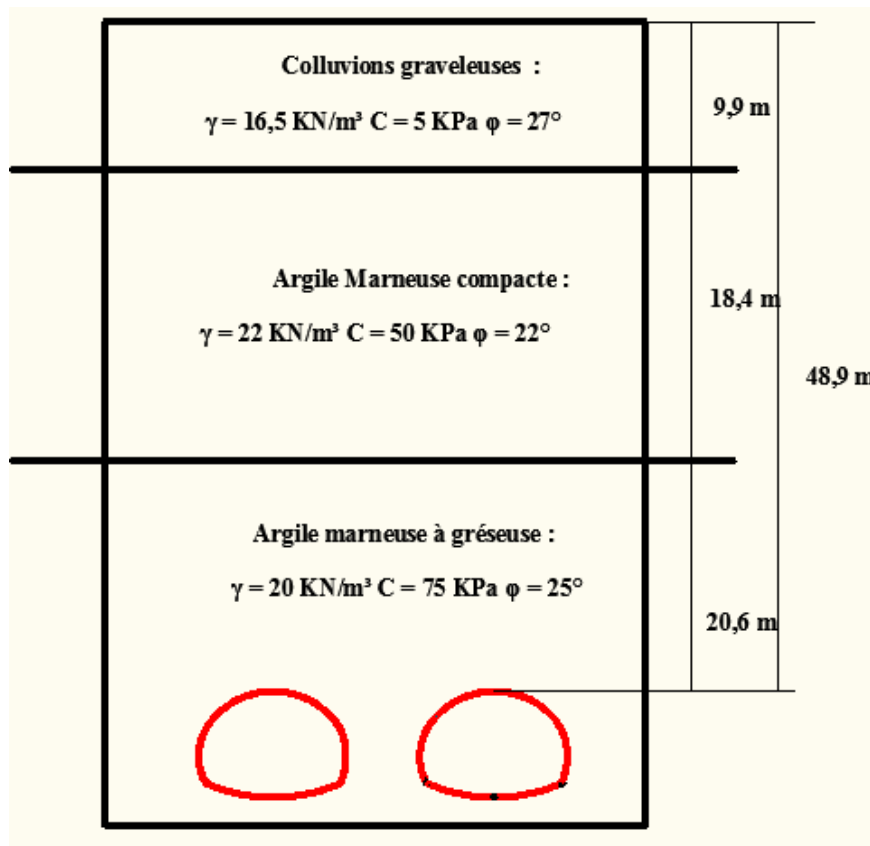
Coupe transversale de la partie de calcul de tunnel
